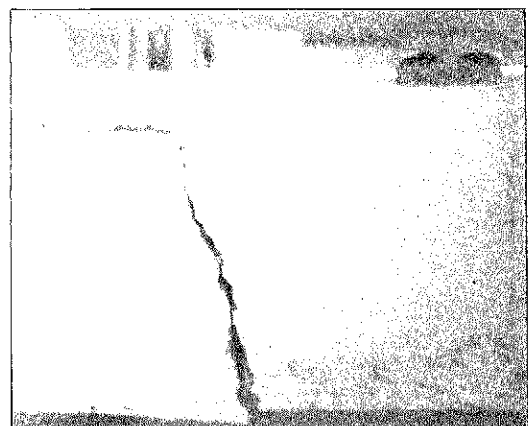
Fisura en apoyo vano (7M.I).
